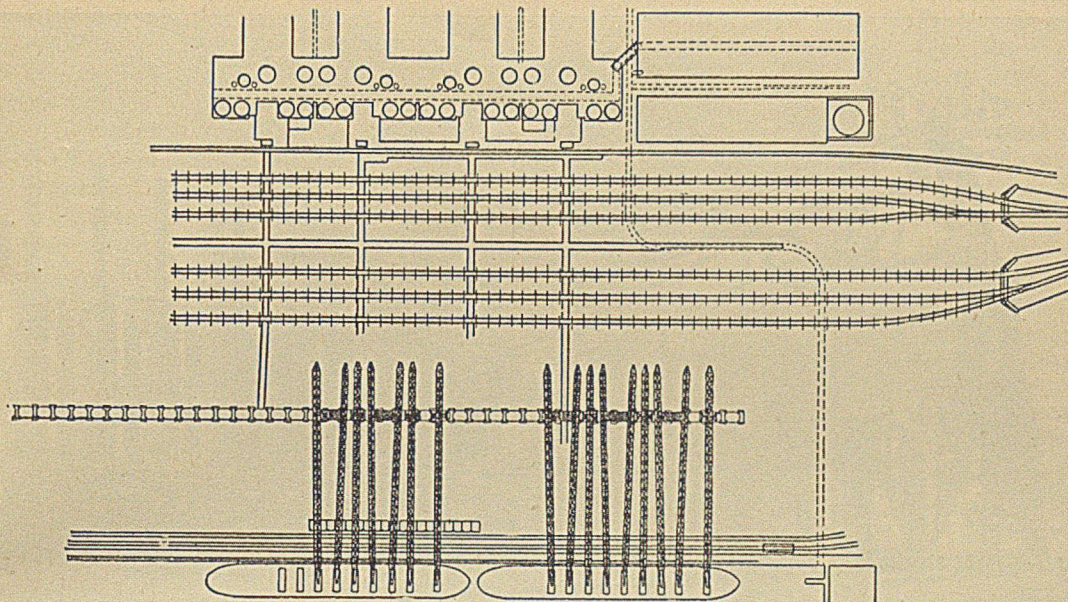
Plan der Hochofenanlage der Illinois Steel Company mit 16 Verladevorrichtungen.
